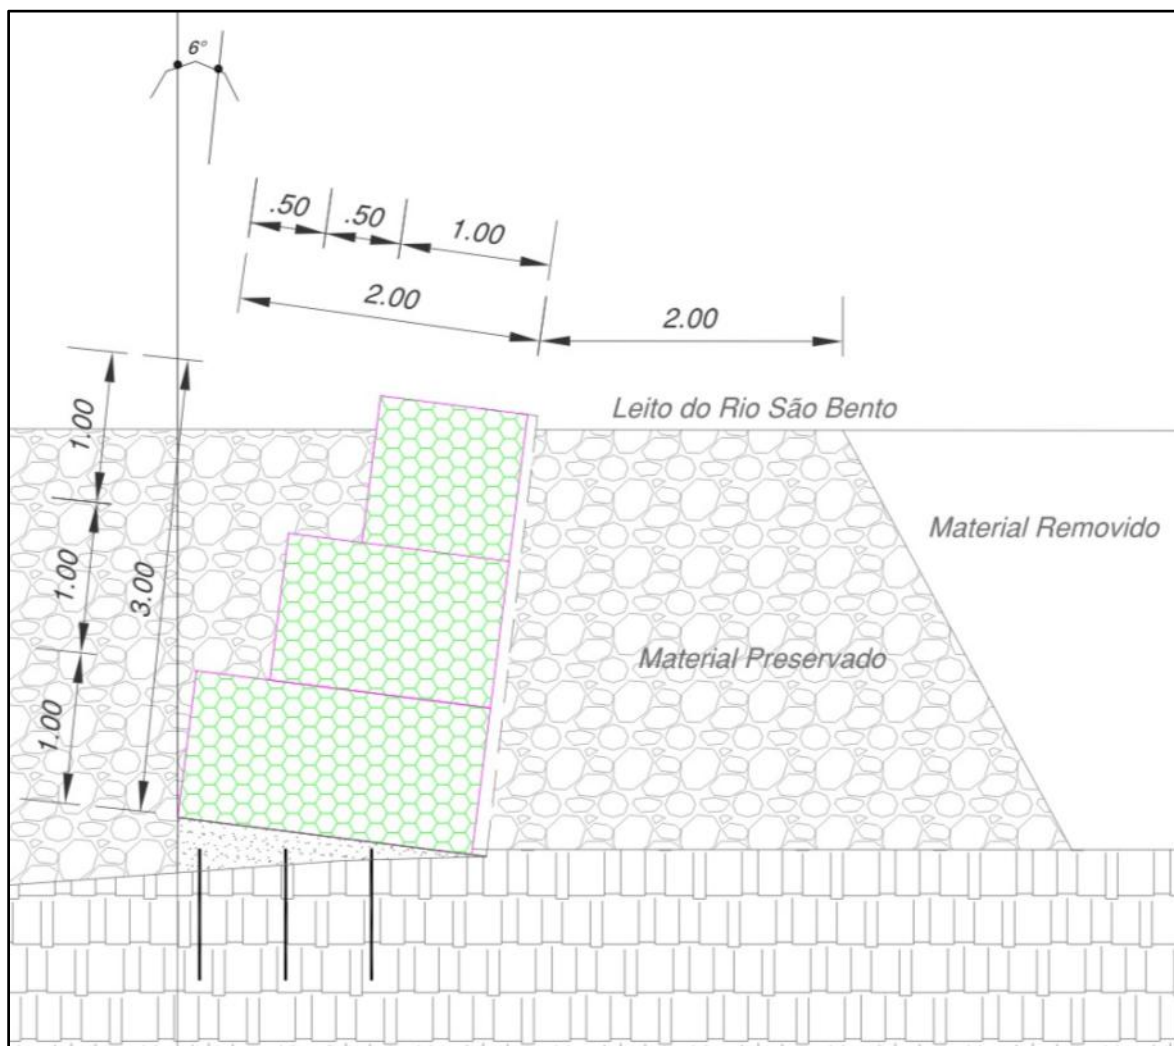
Desenho do modelo da estrutura proposta para barragem de contenção de sedimentos, com determinação da faixa de segurança de escavação.
